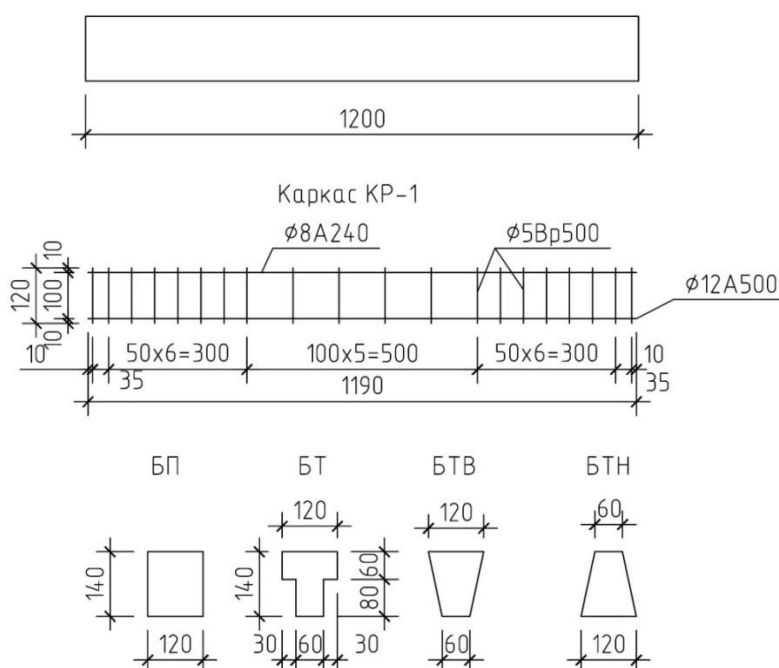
Геометрические размеры и схема армирования балок БП, БТ, БТВ и БТН
